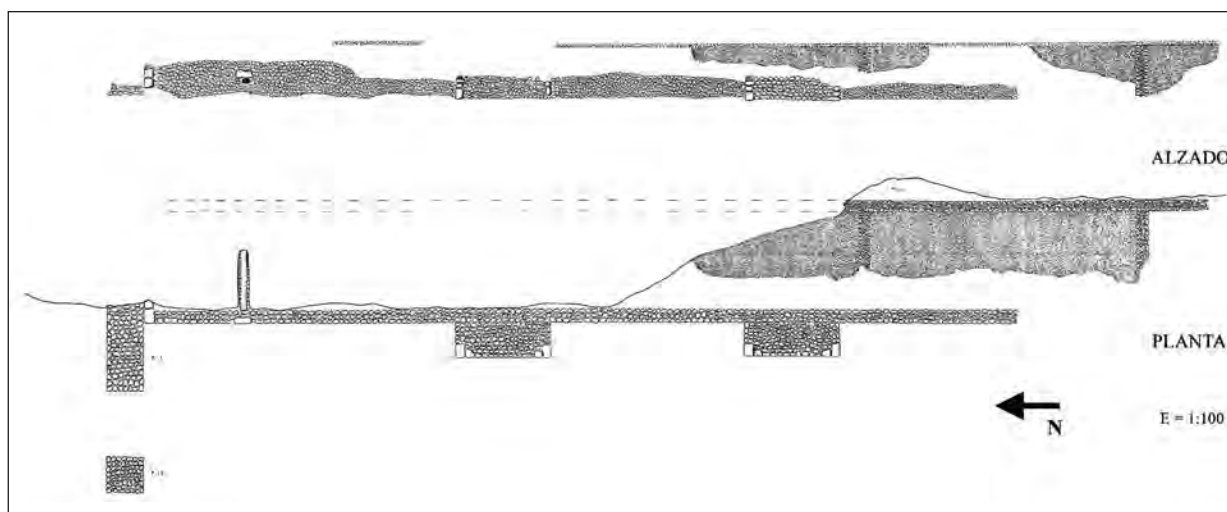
Alzado y planta de las estructuras de contención de las termas occidentales, según la planimetría de Ramos Molina.
